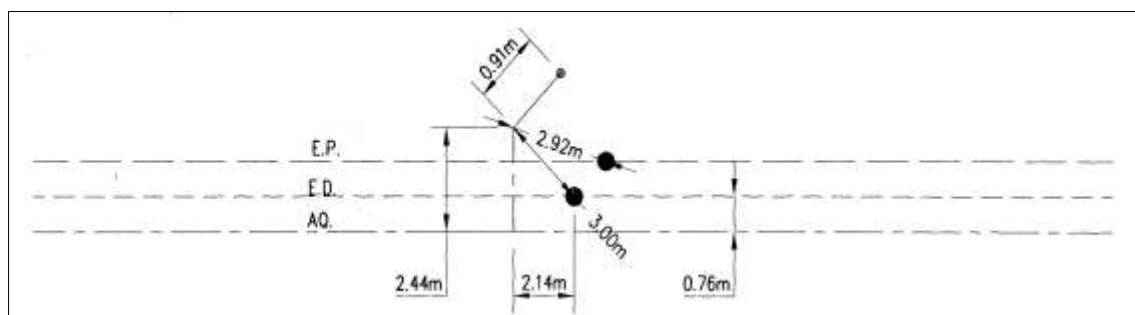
Longueur de conduites à indiquer aux plans TQC
